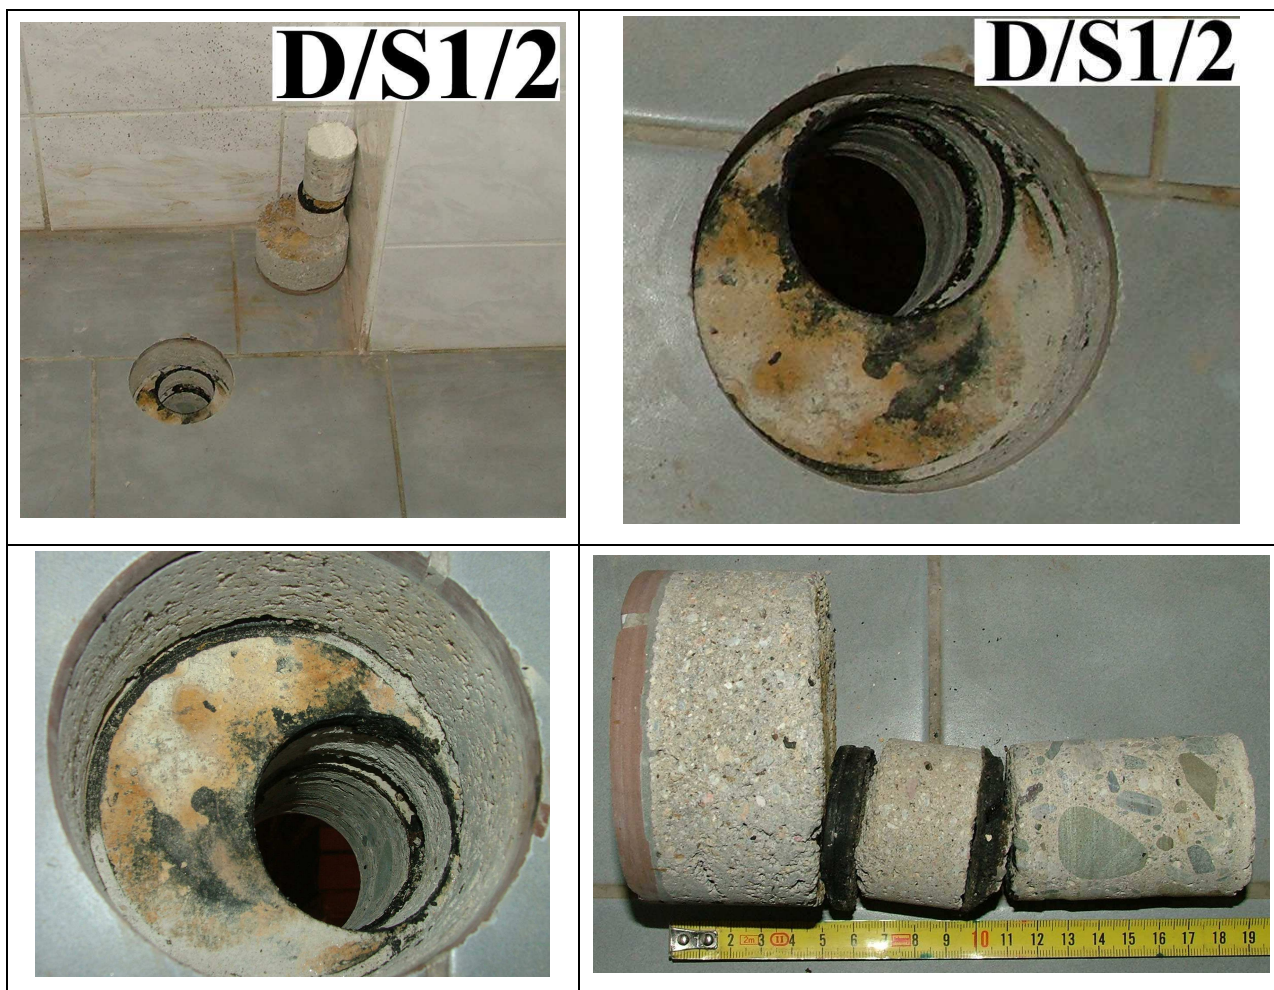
Sonda D/S1/2, podlaha 1. NP (WC), stropní konstrukce nad skladem v 1. PP
